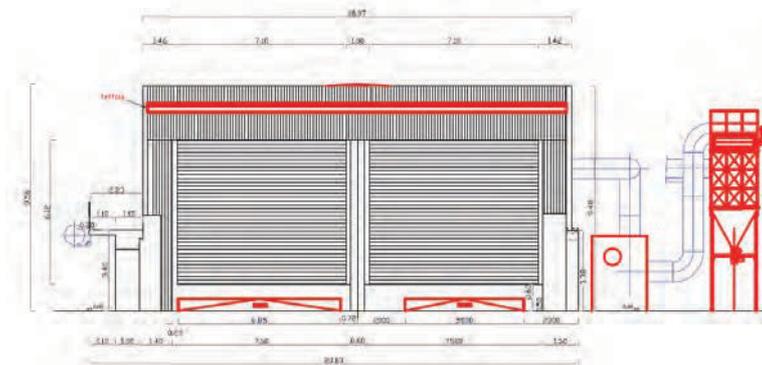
Prospetto frontale del capannone CDR (estratto da Tavola 4, Tavola comparativa pianta prospetti e sezioni, ENEL).
